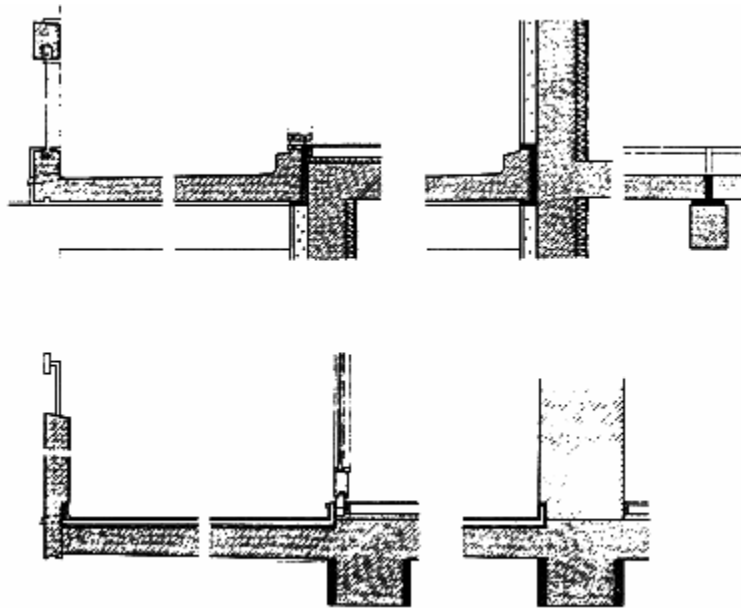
Impermeabilização e drenagem de águas pluviais
